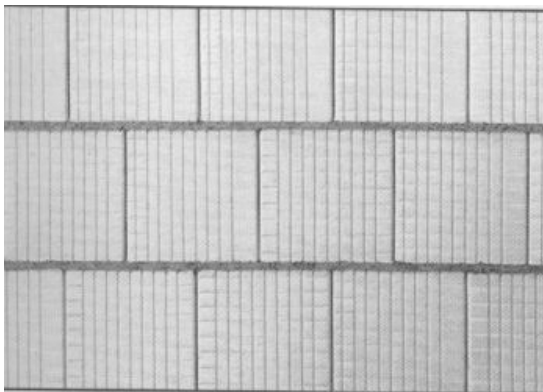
Hochlochziegel-Mauerwerk mit mörtelfreier Stoßfuge.
